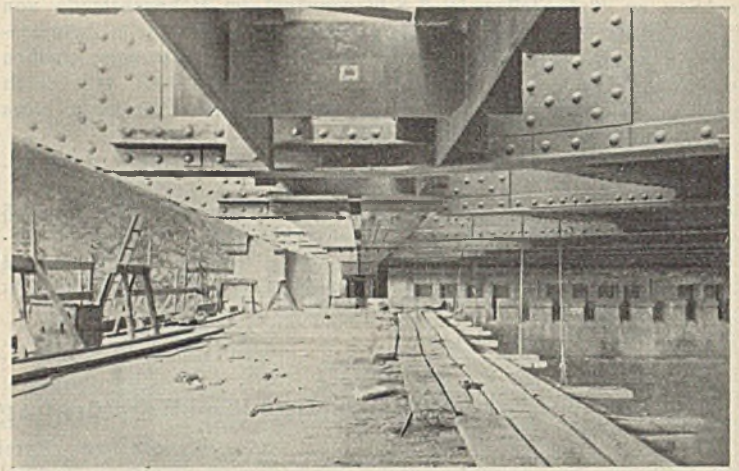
Anschweißen der Gurtlamellen bei entlasteter Fahrbahn.
